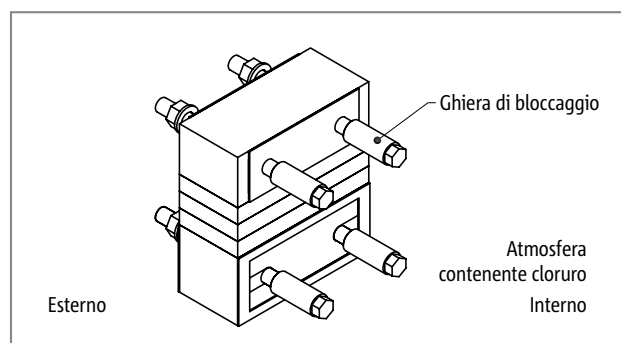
Schöck Isokorb® T tipo S con ghiera di bloccaggio: isometria; interno contenente cloruro
